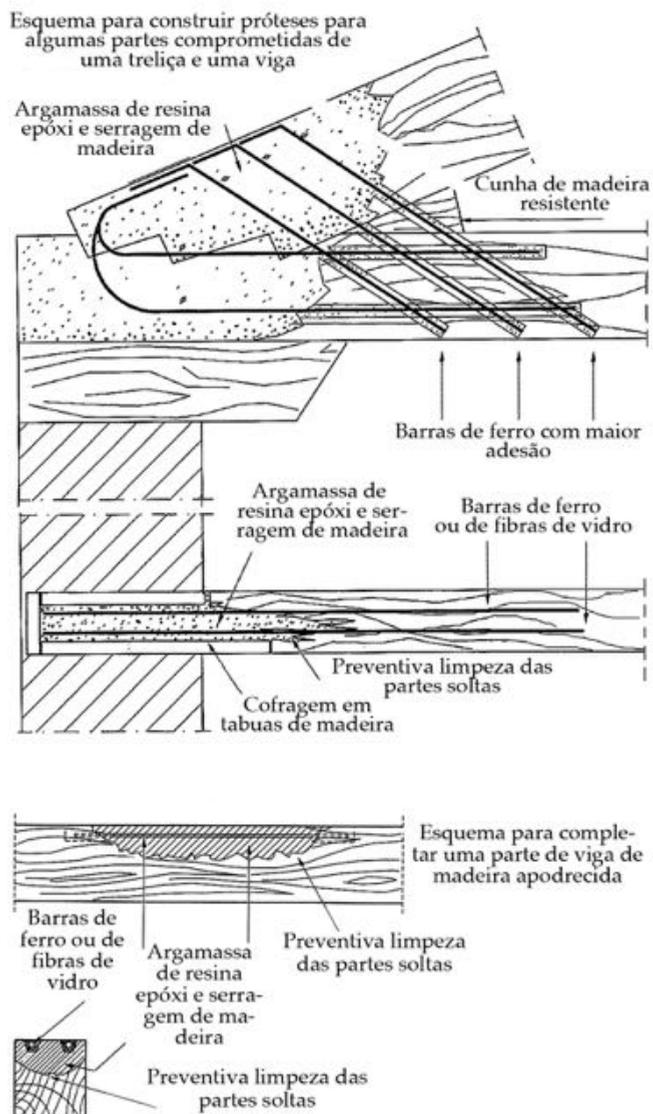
Projecto para a reconstrução de duas cabeças e de uma porção apodrecida em vigas de madeira com execução duma betonagem de resina epóxi e serradura armada com barras de fibras de vidro.
